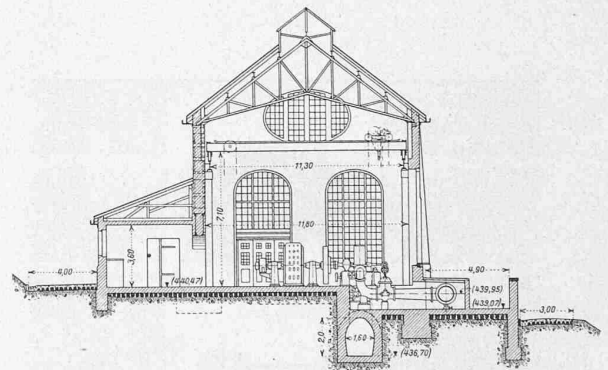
bis 23. Grundriss und Schnitte vom Maschinenhaus. — 1 : 400.
